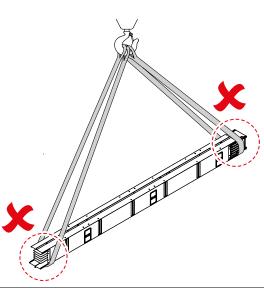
Non sollevare i condotti sbarre dalle estremità
